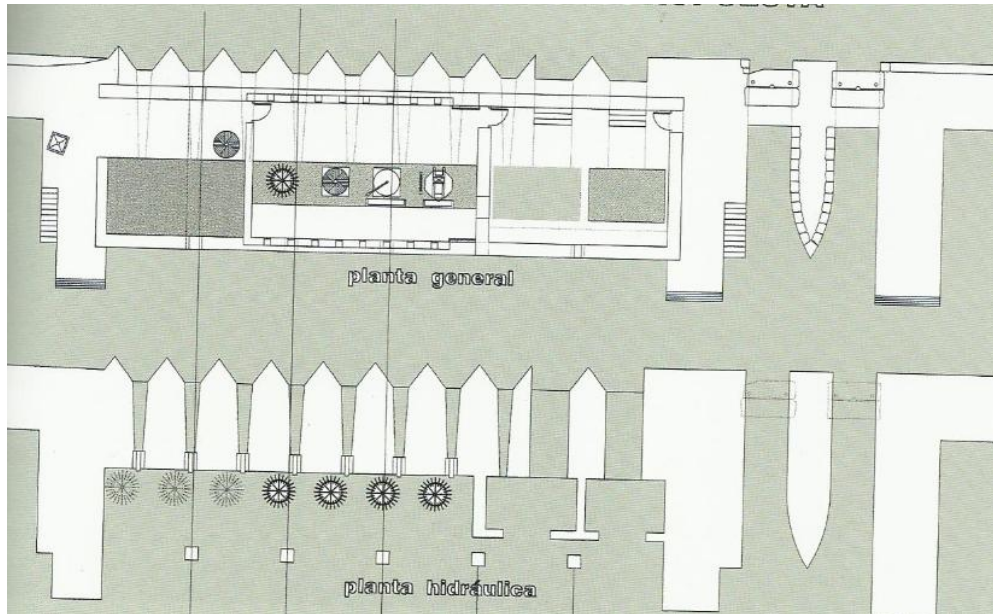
Planta general e hidráulica del Molino de Santa Olaja.
